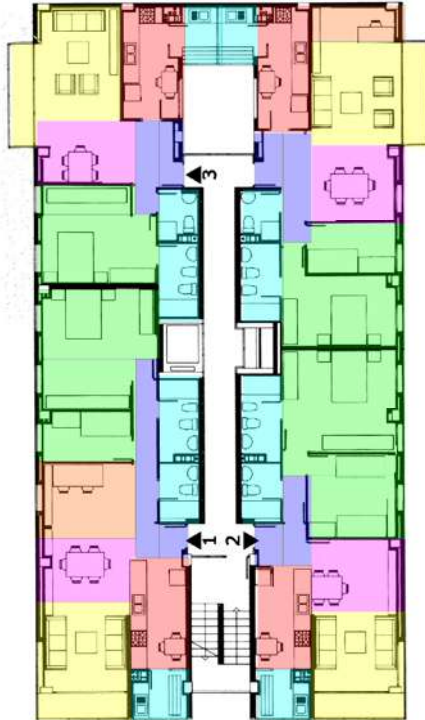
Planta Pavimento Tipo - Intervenção da Autora
